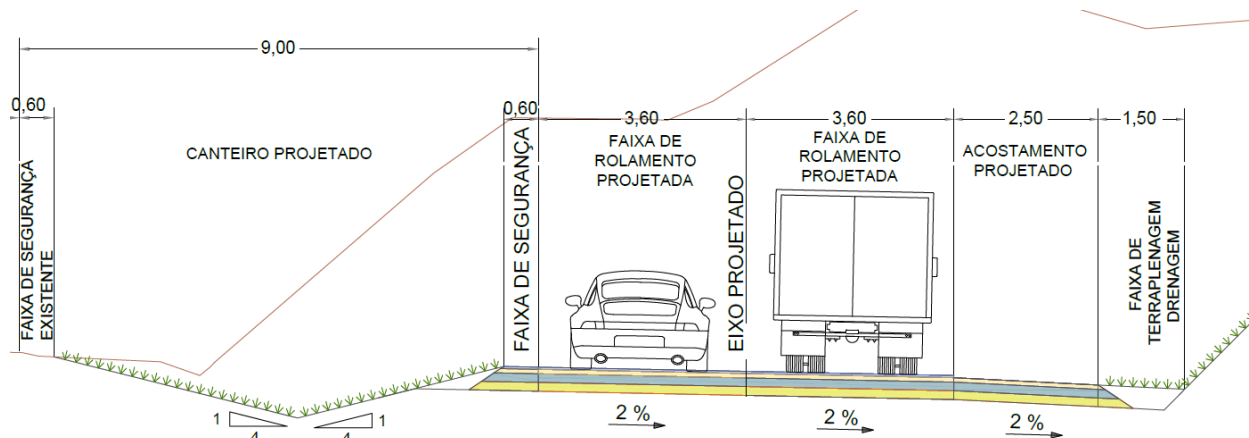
Seção Tipo – Duplicação com Canteiro Central de 7,00 m
